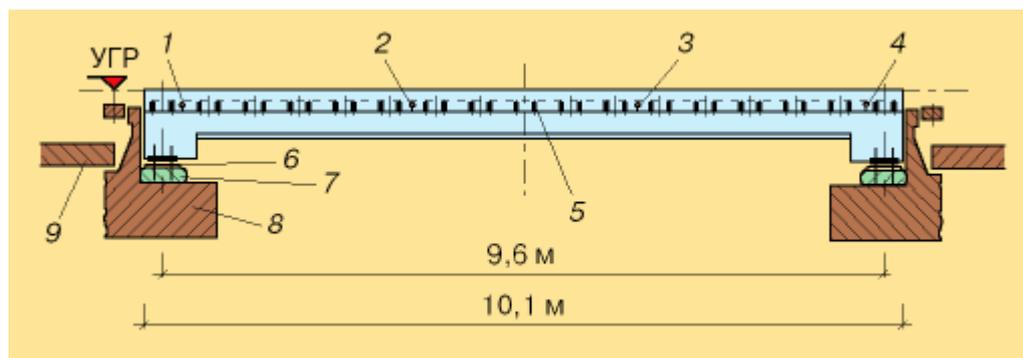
Пролетное строение типа WIB длиной 9,6 м: 1, 2, 3, 4 – анкеры для подъема балки при монтаже одним и двумя кранами; 5– приварные болты для установки рельсовых креплений; 6 – опора из эластомера; 7 – переходная опора; 8 – устой с площадкой для опорной конструкции; 9 – упорная плита [77]
